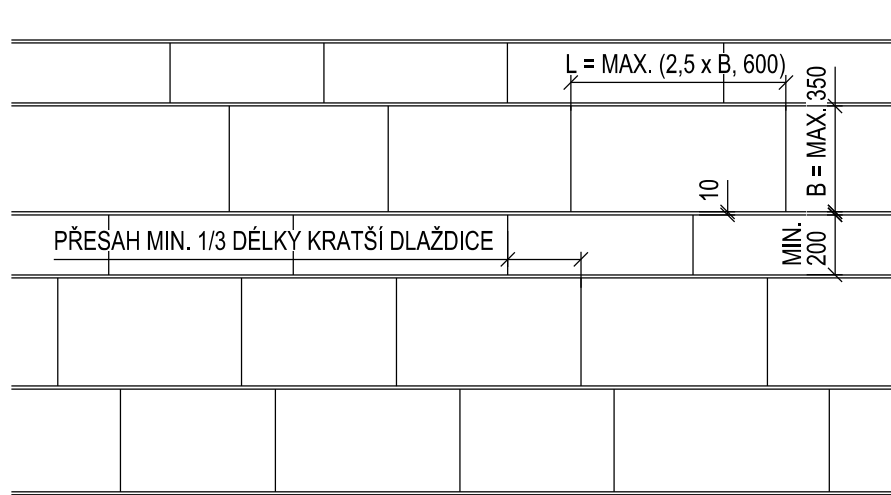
PŮDORYSNÝ DETAIL UKONČENÍ DLAŽBY, 1:10
